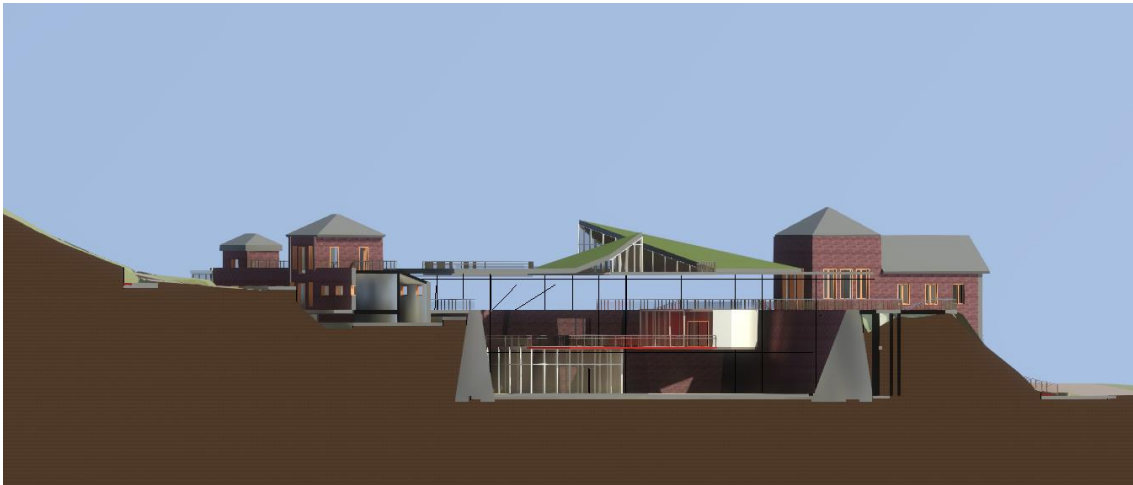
Otro corte transversal con la propuesta final para el depósito sur.
